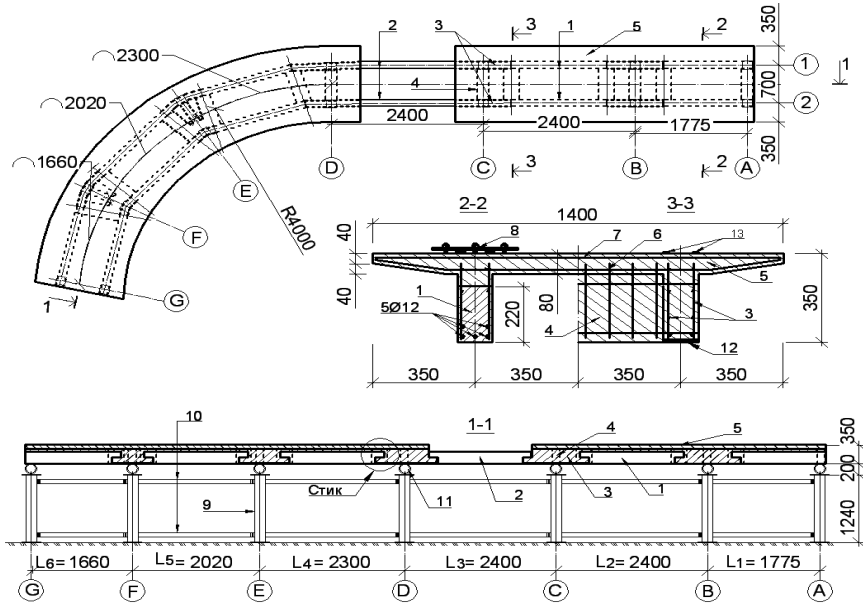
План і розрізи моделей двобалкових збірно-монолітних нерозрізних залізобетонних конструкцій прогонових будов мостів: 1 – прогонові збірні залізобетонні балки; 2 - підвісна збірна балка на консолях двох незалежних моделей; 3- закладна деталь надпорної монолітної балки; 4- діафрагма; 5- монолітна плита із консолями; 6- нижня сітка плити; 7- верхня сітка плити; 8- деталь для анкерування неметалевої арматури Sika CarboDur S212; 9- опори стенду; 10- поздовжні металеві зв'язки опор; 11- кільцеві динамометри; 12 – зовнішня листова арматура надпорних монолітних ділянок; 13 – неметалева стрічкова арматура Sika CarboDur S212
